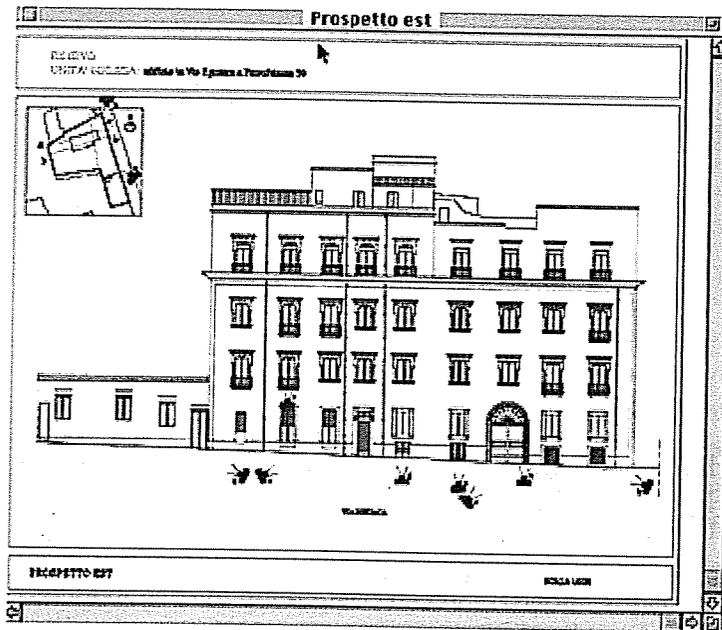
Il Prospetto Est su cui si trovano le tracce del '500
